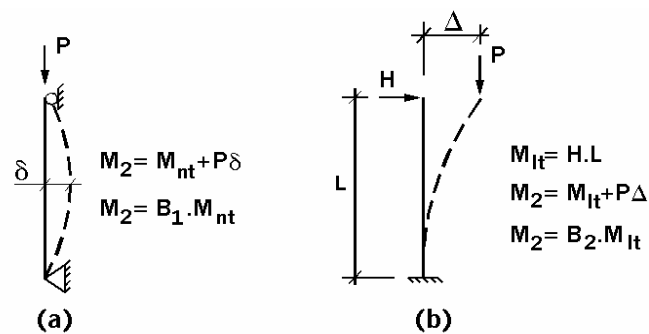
Efeitos de 2ª ordem: (a) Pilar contraventado, (b) Pilar não-contraventado
